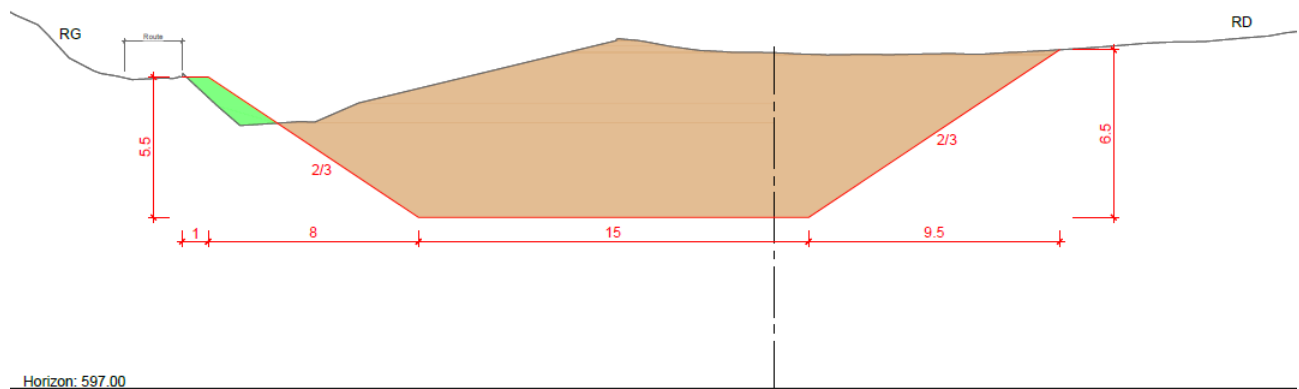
Profil en travers de la variante 2 de plage de dépôts sur l'Uguine – PK 2.841
